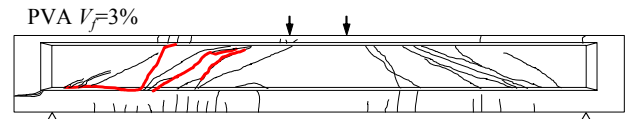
PVAを用いたUFGはりのひび割れ状況
